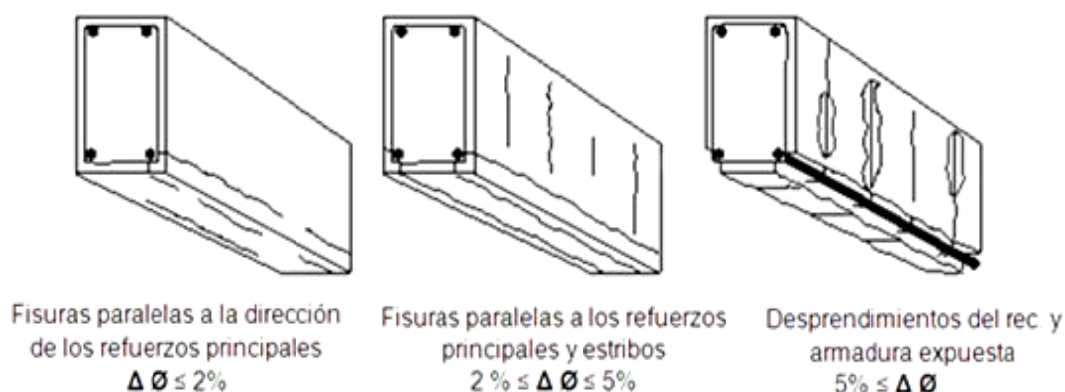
Representación esquemática sobre la evolución de la fisuración en vigas de hormigón armado afectadas por corrosión (HUSNI et al. 2007)
